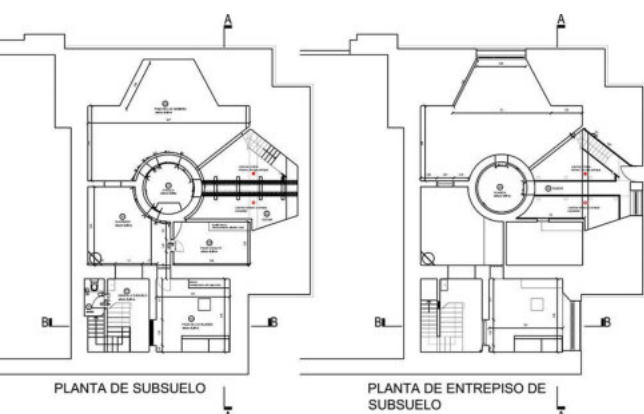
Planta de subsuelo y de entepiso a modo de panóptico. Puente de estructura metálica sobre la traza de un muro demolido para su ejecución.
